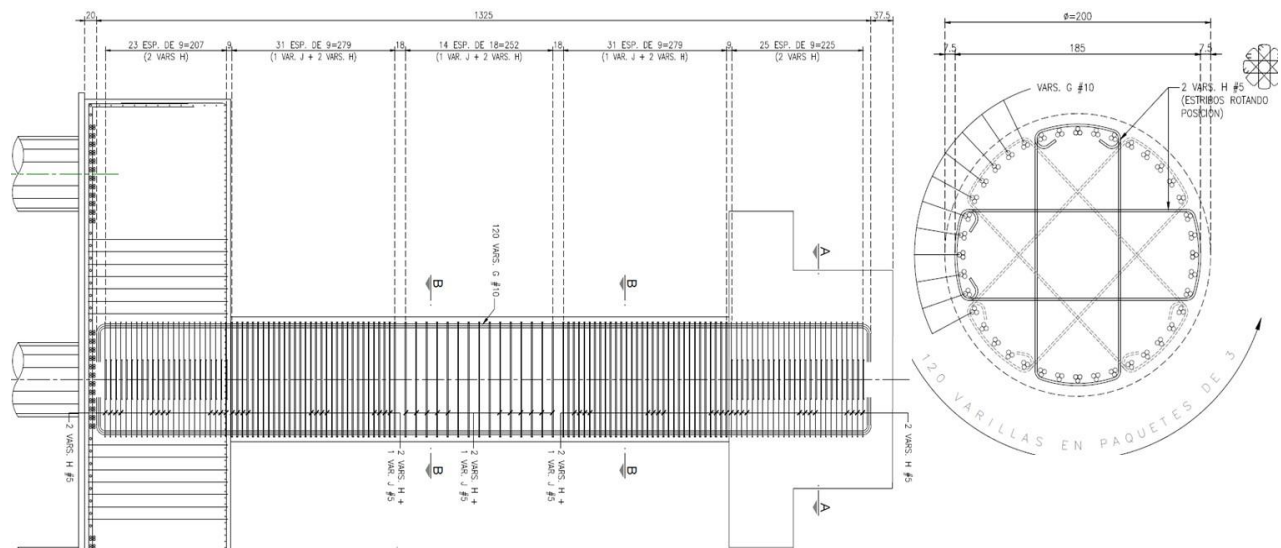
ARI Ingeniería (2023) "Arreglo de armado de acero de refuerzo para columnas de pórticos (Apoyo 10 y 15)"
